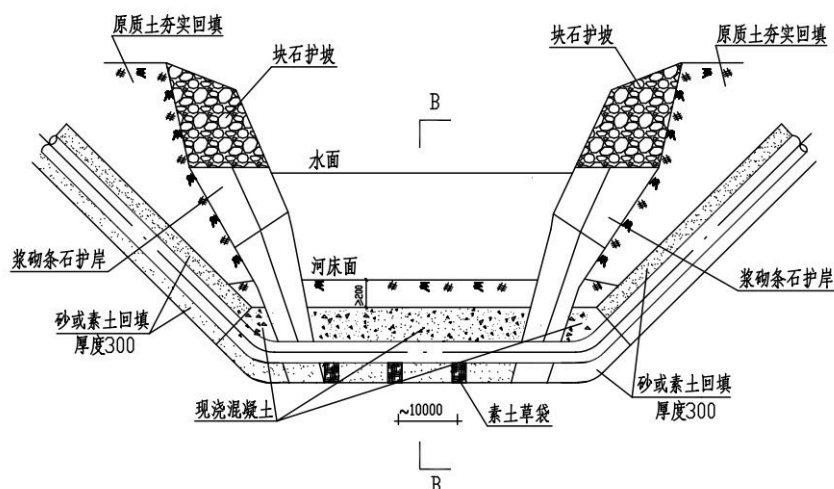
典型小河穿越稳管措施施工断面示意图
